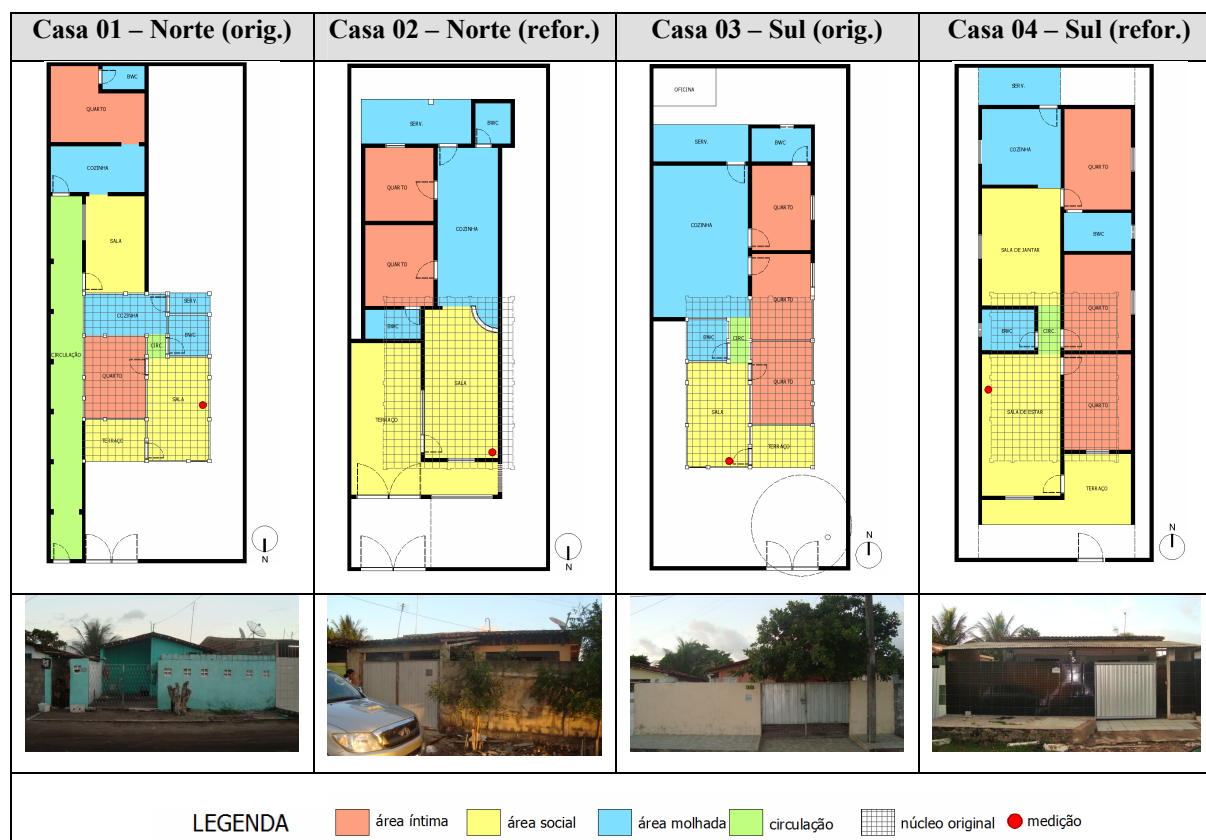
Plantas baixas das casas analisadas e respectivas fachadas.
